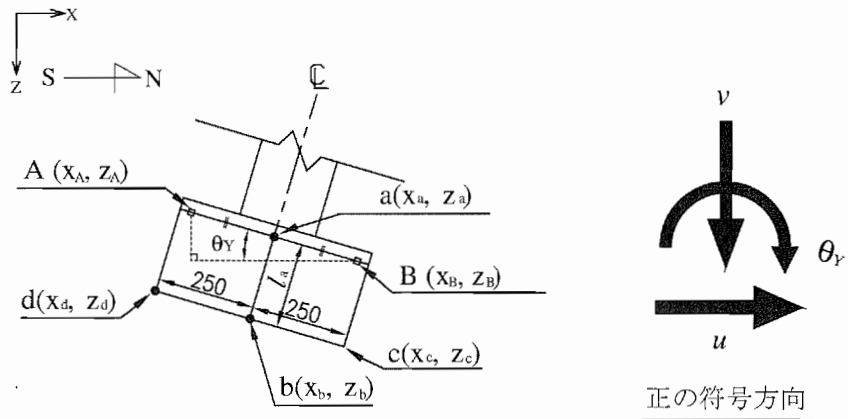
基礎変位の算出概念図 (X-Z 平面)
